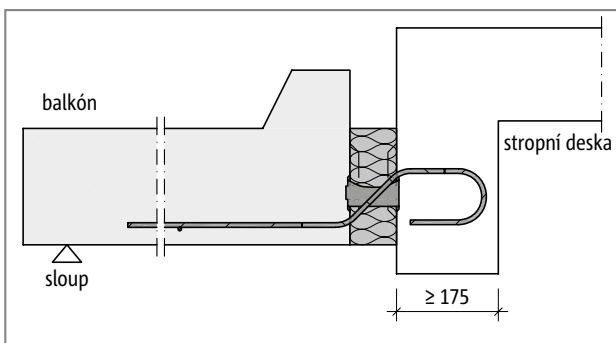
Schöck Isokorb® typ Q, QP-VV: Balkón uložený ze dvou stran, se sloupovou podporou
